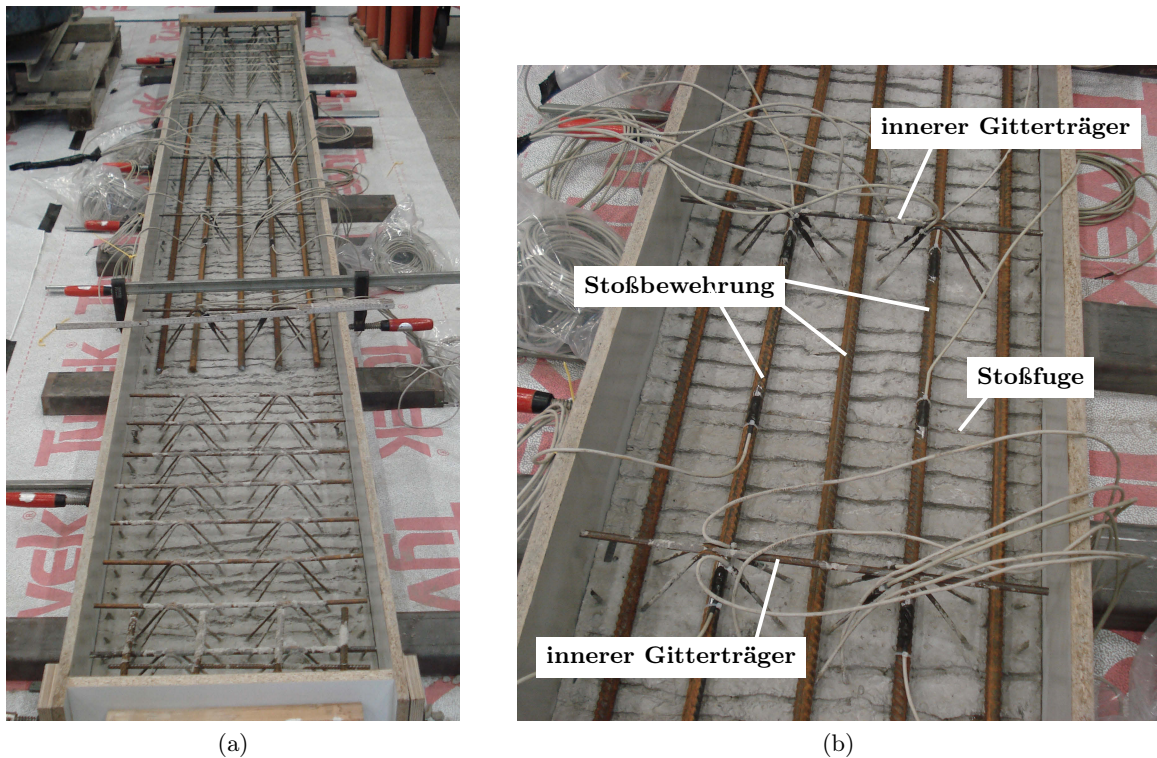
Betonage des Prüfkörpers *B5*, (a) Übersicht des Prüfkörpers, (b) Detail des Elementstoßes
